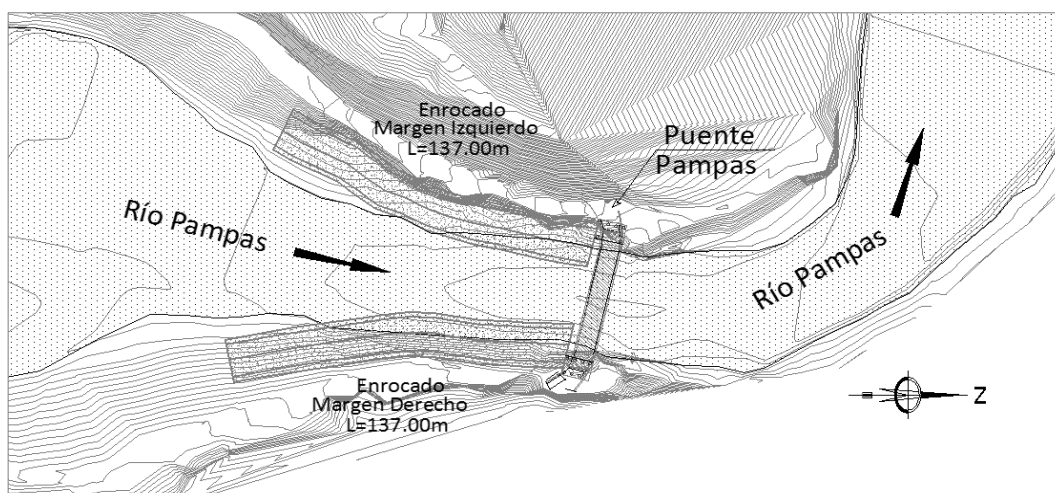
Esquema en planta del puente Pampas y obras de protección de riberas.
